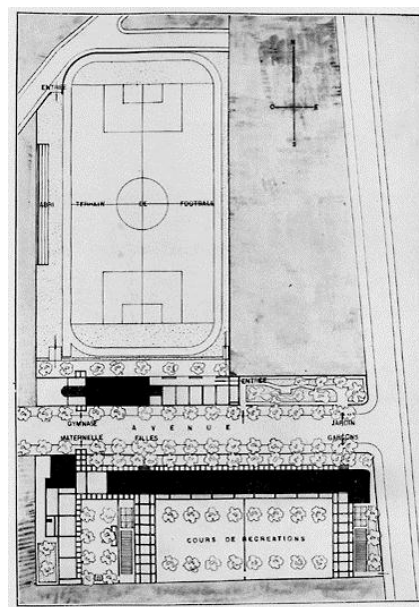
Planta de implantação do *Groupe Scolaire Karl Marx*.
